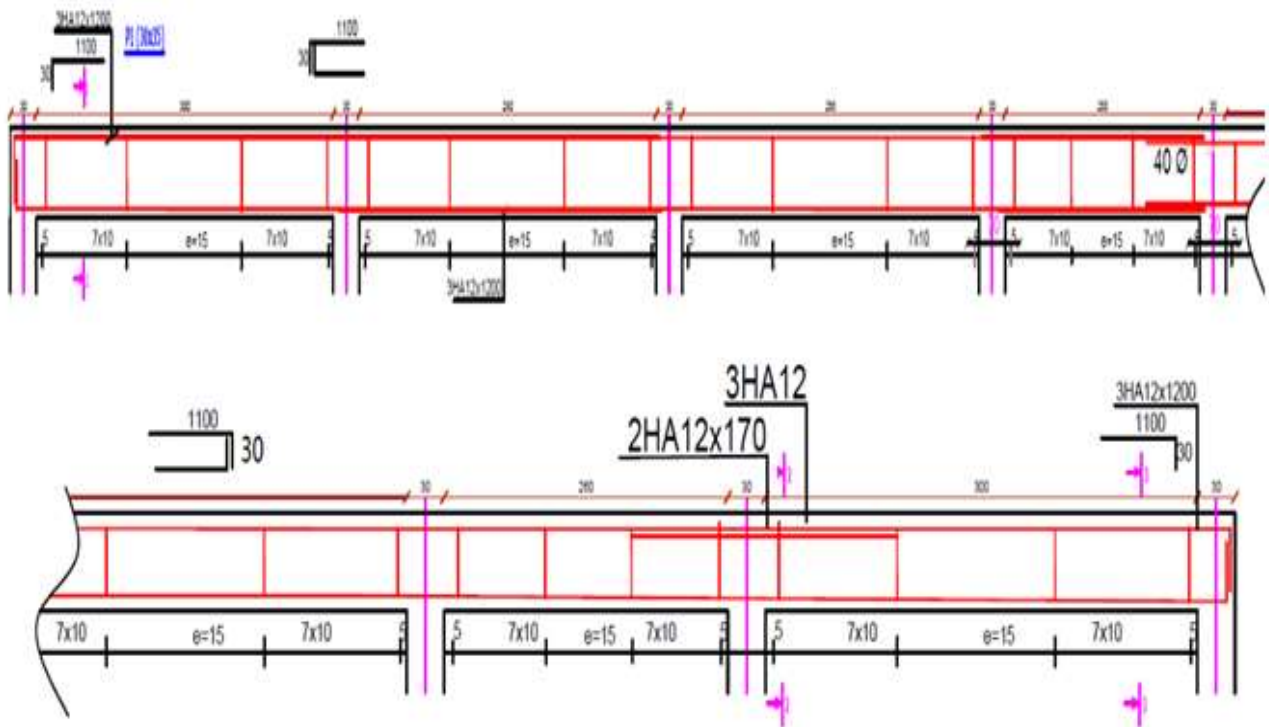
coupe longitudinale de la poutre secondaire (30x35)
